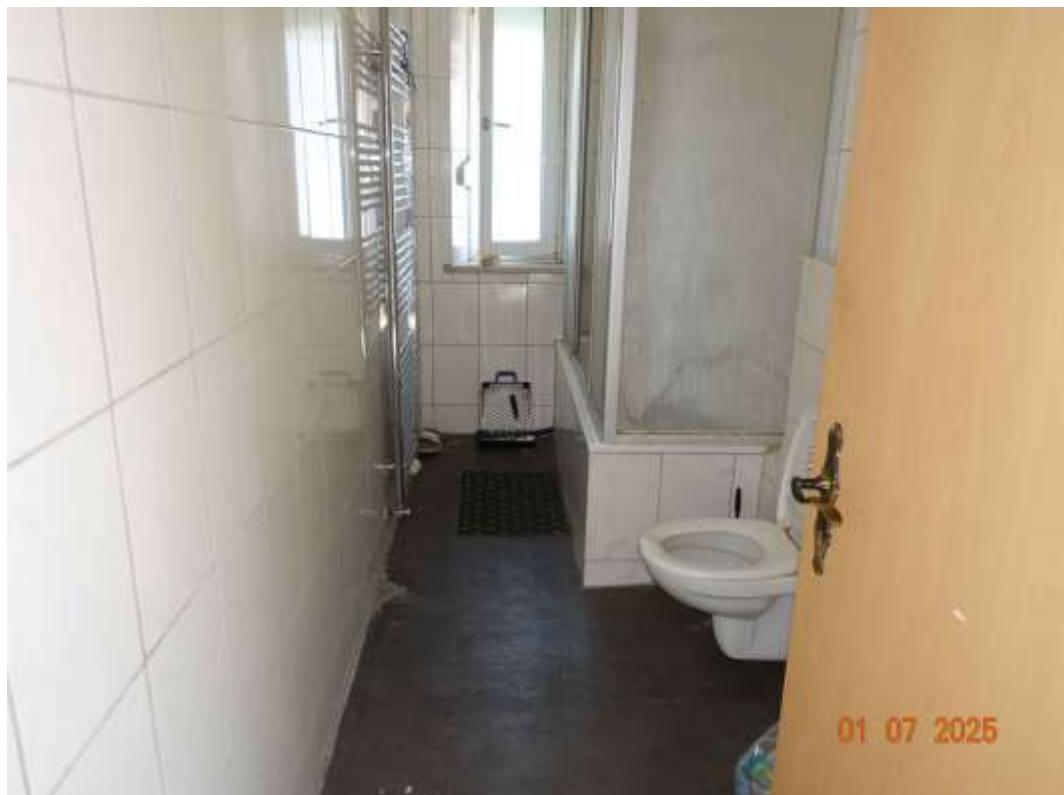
Bildausschnitt vom Bad im Obergeschoß
